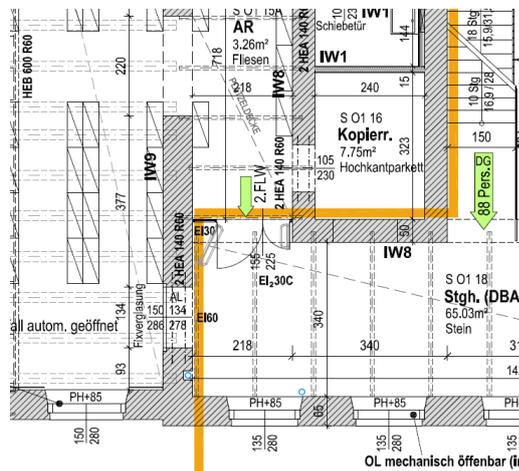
Planausschnitt Bestandsplan S0118_1
